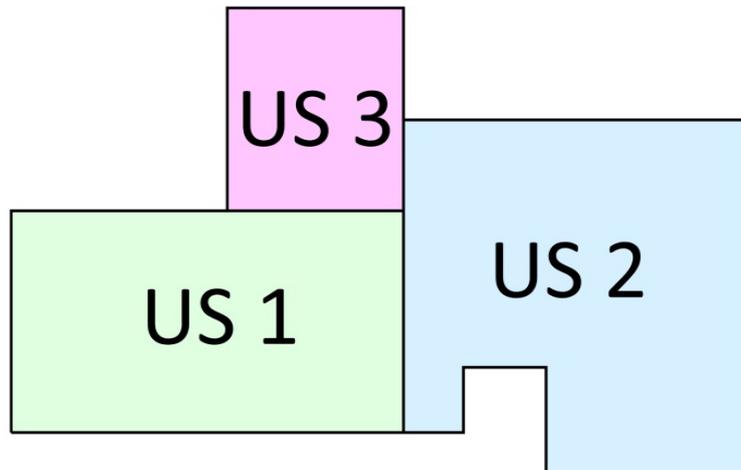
Suddivisione dell'edificio in Unità Strutturali.
